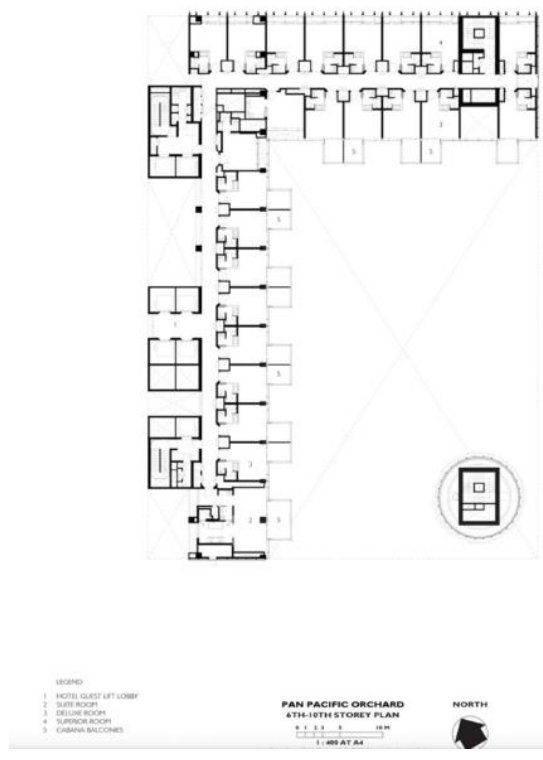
План 6-го і 10-го поверхів (готель Pan Pacific Orchard) [1]
